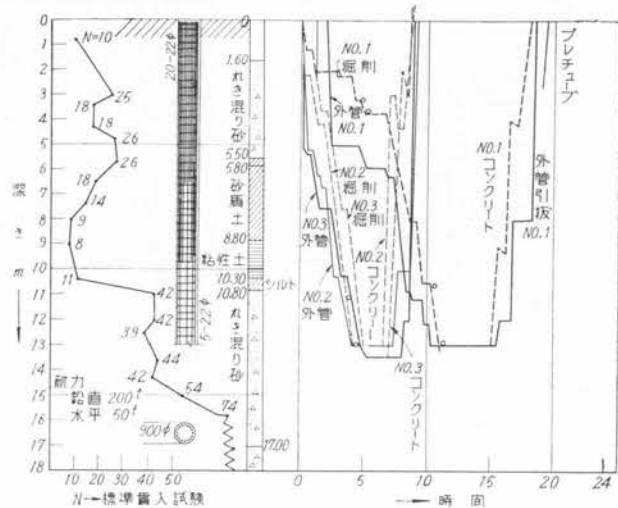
直径 900 mm, 長さ 13.00 m くい施工図
